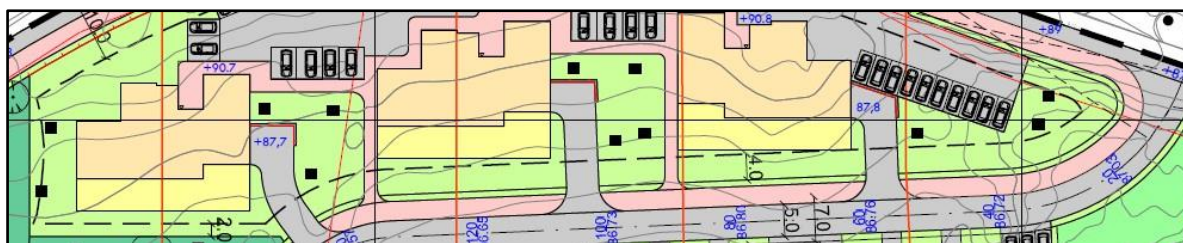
Illustrasjonsplanen som følger planforslaget og viser hva planendringen tilrettelegger for.
